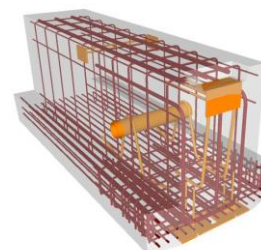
18 B1010.10-LOD 400: Viga T invertida estrutural pré-fabricada de concreto<sup>21</sup>
